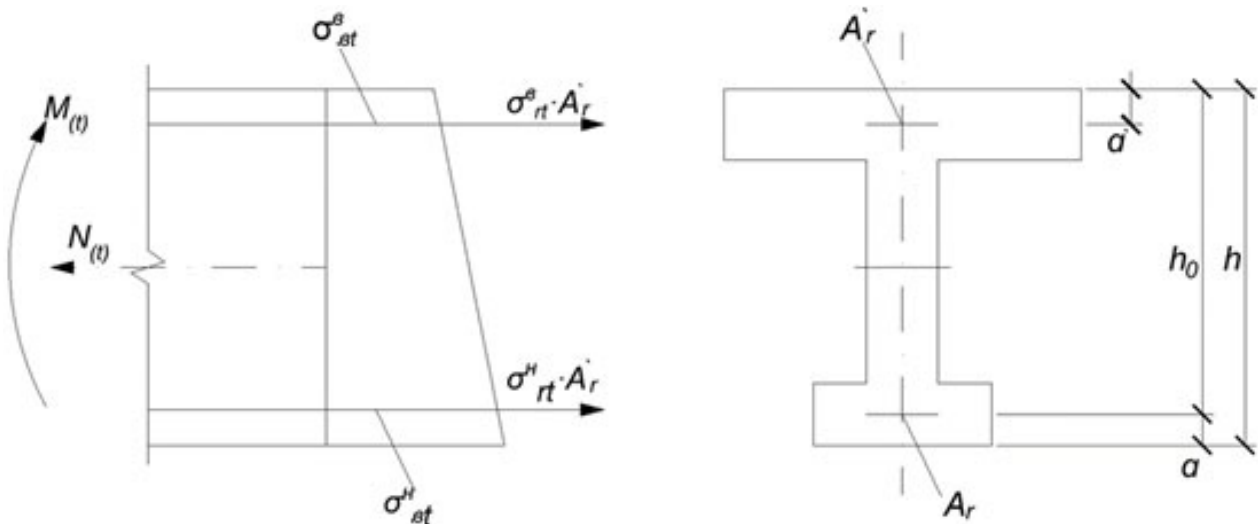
Напруження і зусилля у поперечному перерізі залізобетонної балки
